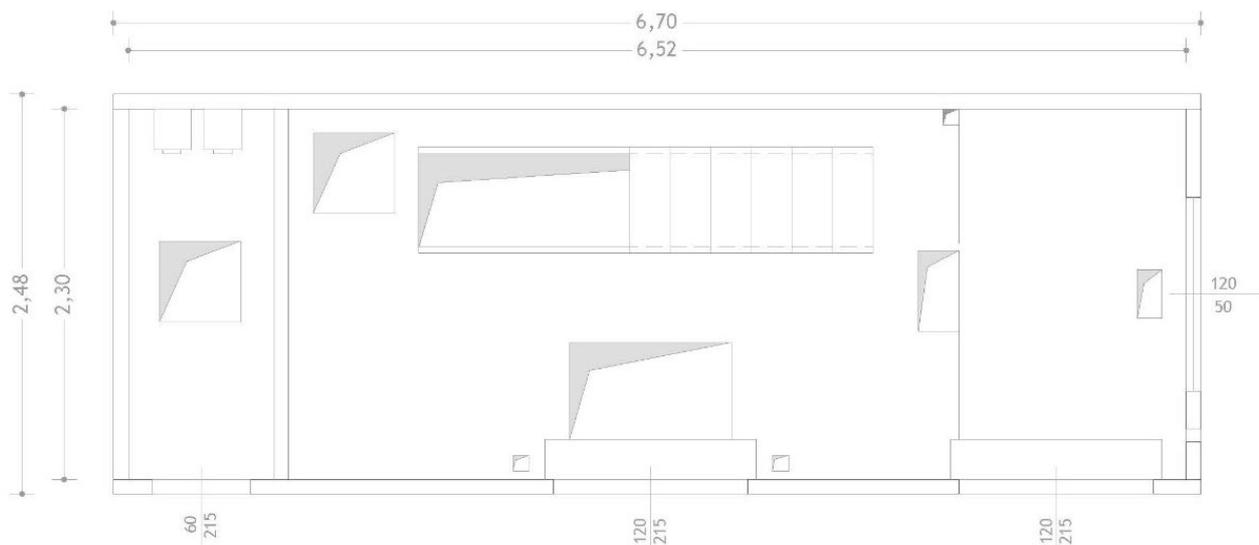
Cabina di consegna: stralcio planimetrico (S.I.A.)
